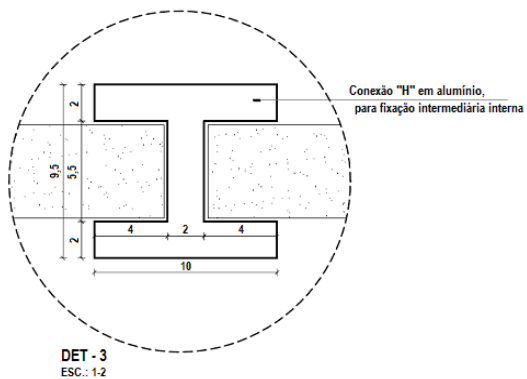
Detalhe da conexão interna em "H" para fixação entre painéis.
